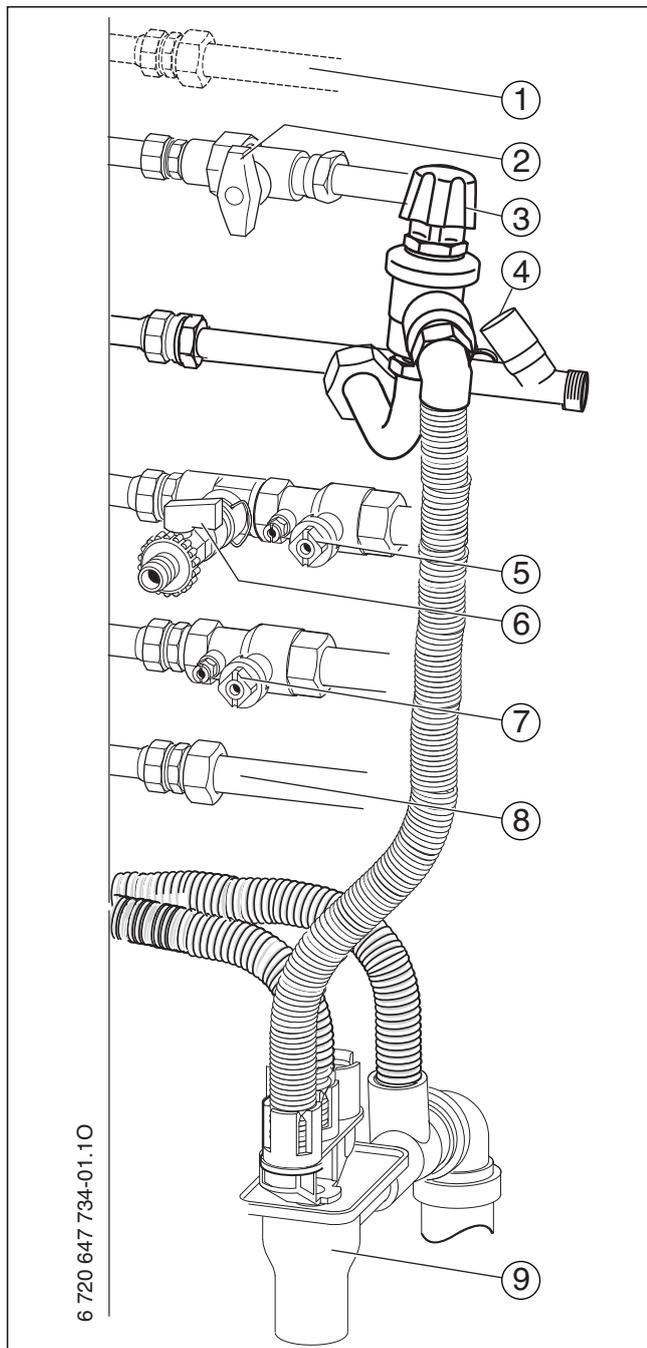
Exemple d'accessoire de raccordement horizontal vers la droite
